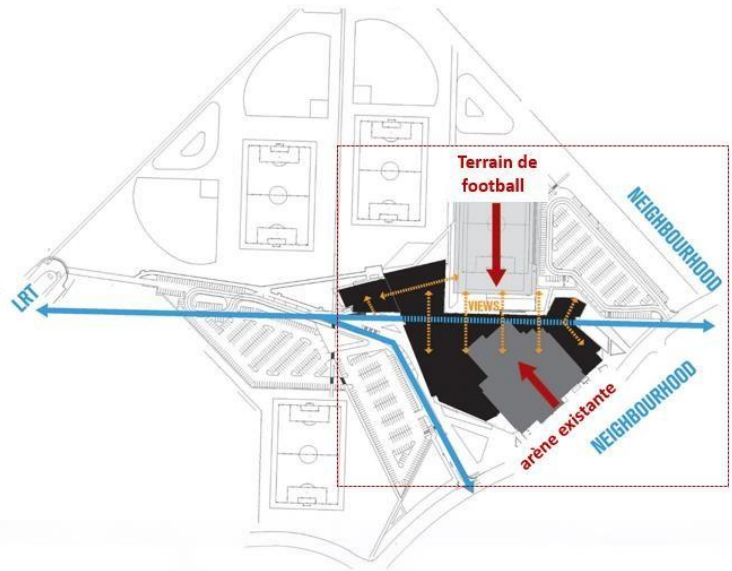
Plan de masse du centre de loisirs Clareview. (Source : Archdaily.com)
